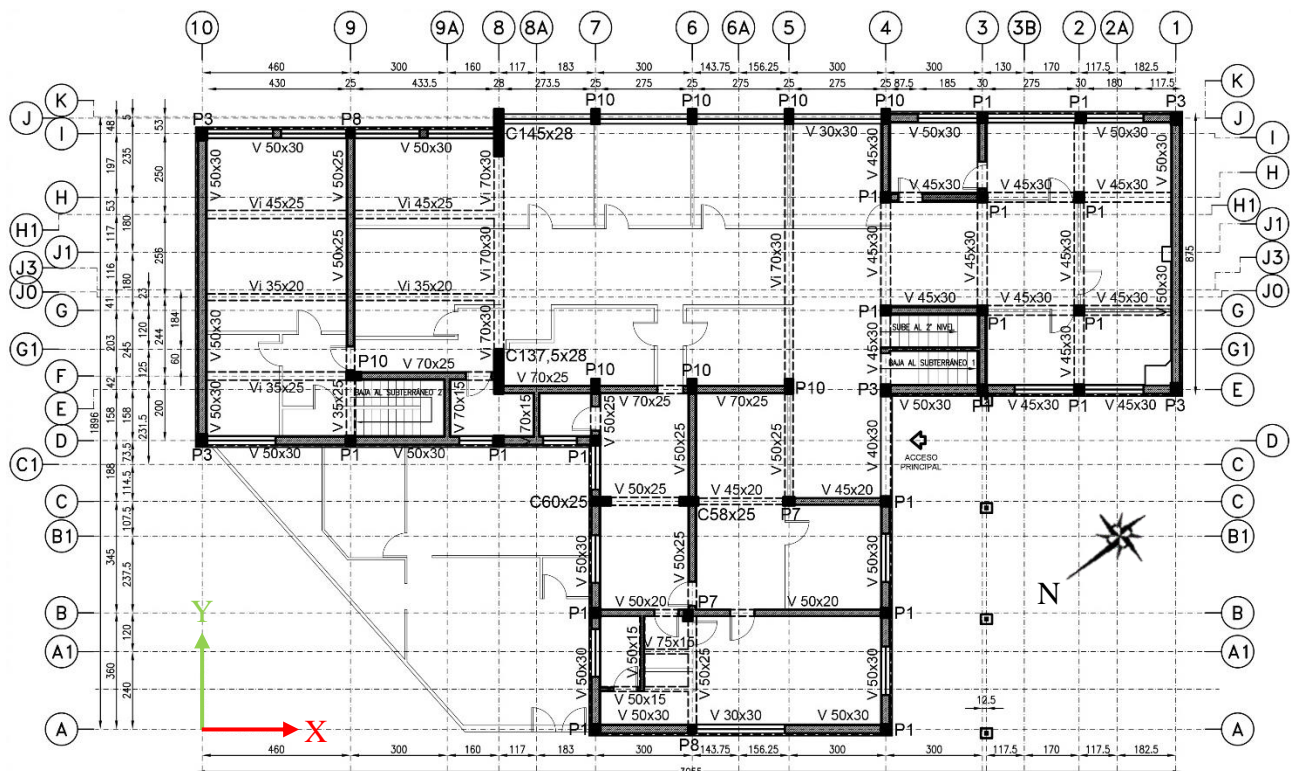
Planimetría del primer nivel del edificio DIDECO.
